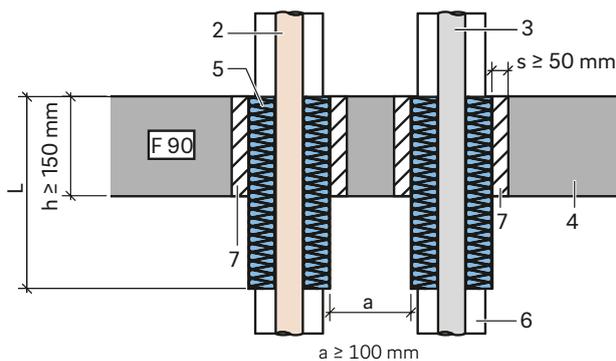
Installation asymétrique dans un plafond massif - face inférieure du plafond
